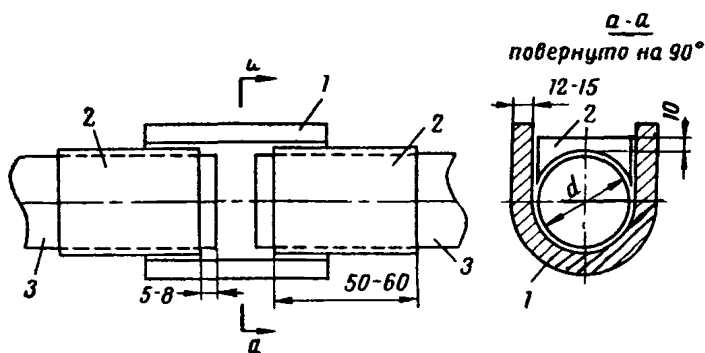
Схема установки желобчатой подкладки 1 и медных вкладышей — ограничителей плавильного пространства 2 при подготовке к ванно сварке горизонтальных стержней 3
